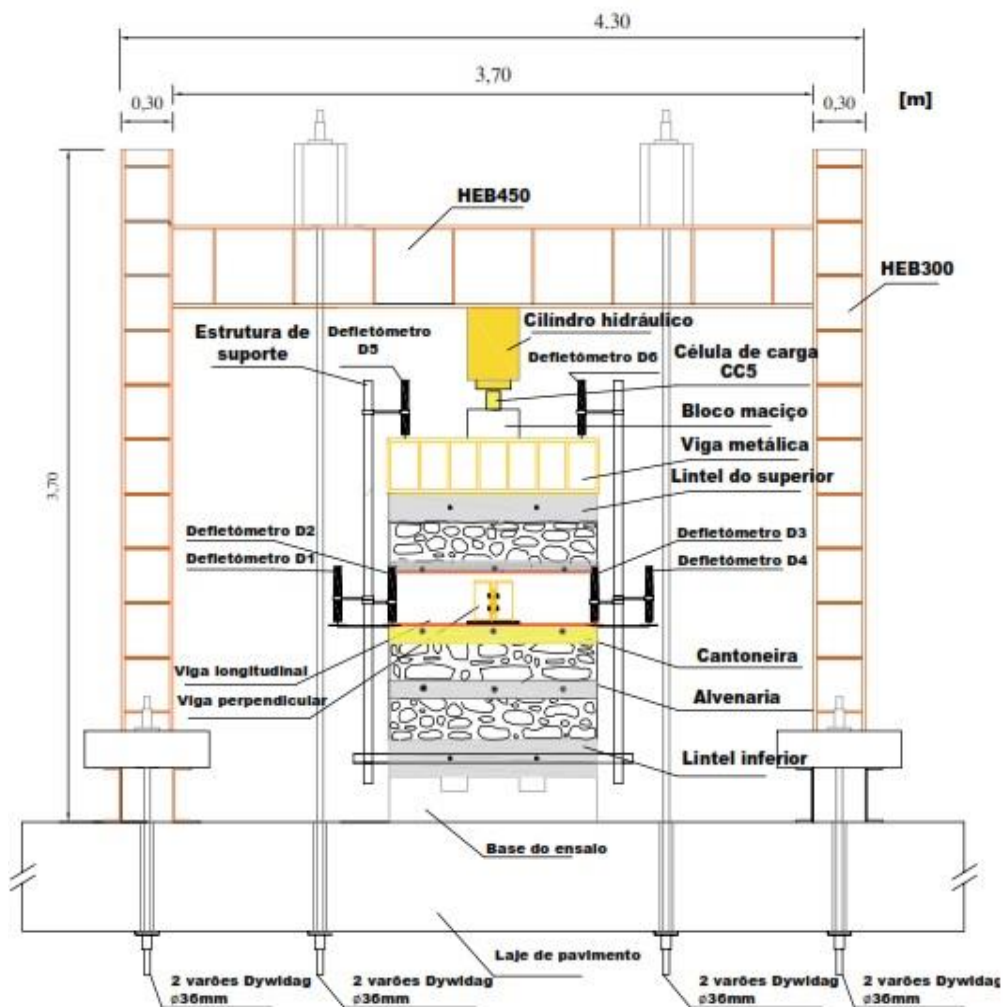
Disposição das vigas metálicas que simulam o pavimento.
